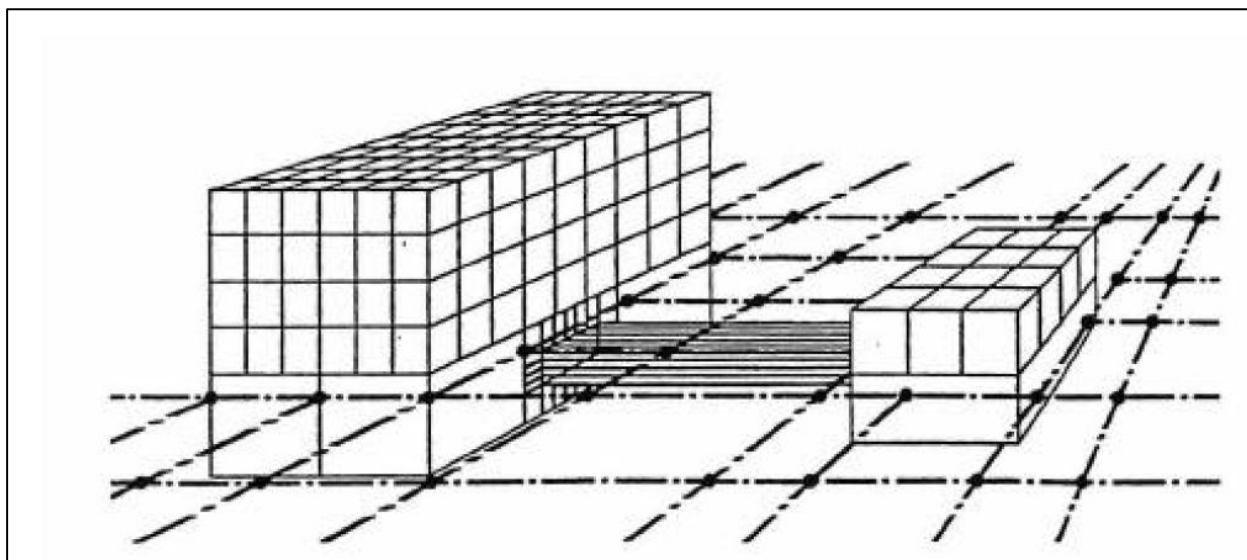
Fundações metálicas do edifício ligadas entre si, gaiola de Faraday.
